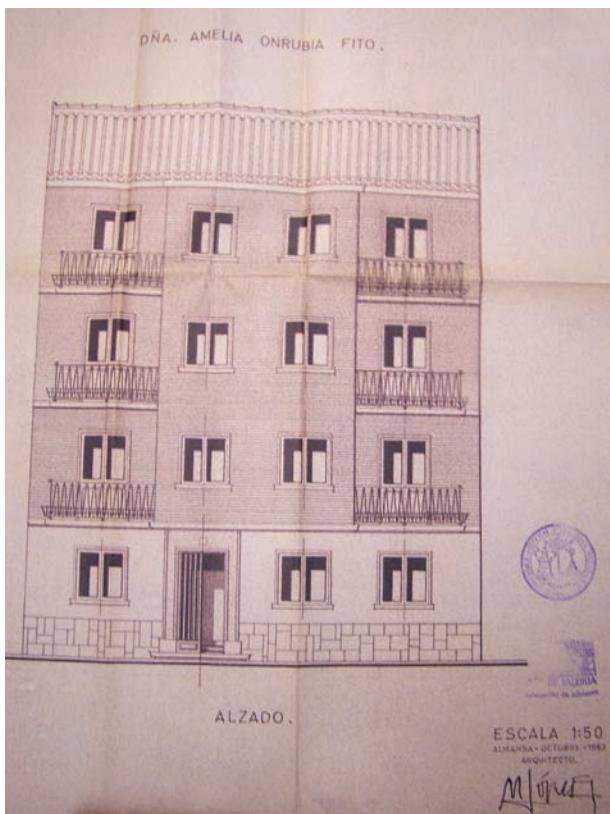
Plano de la fachada de un edificio de viviendas de D. Miguel. AMA, legajo 631-11.
